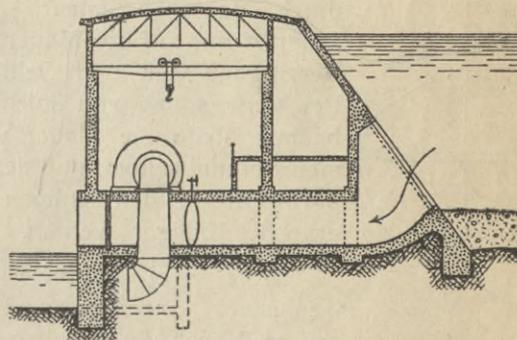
Staudamm in armierten Beton bei Schuylerville im Staate New York.
